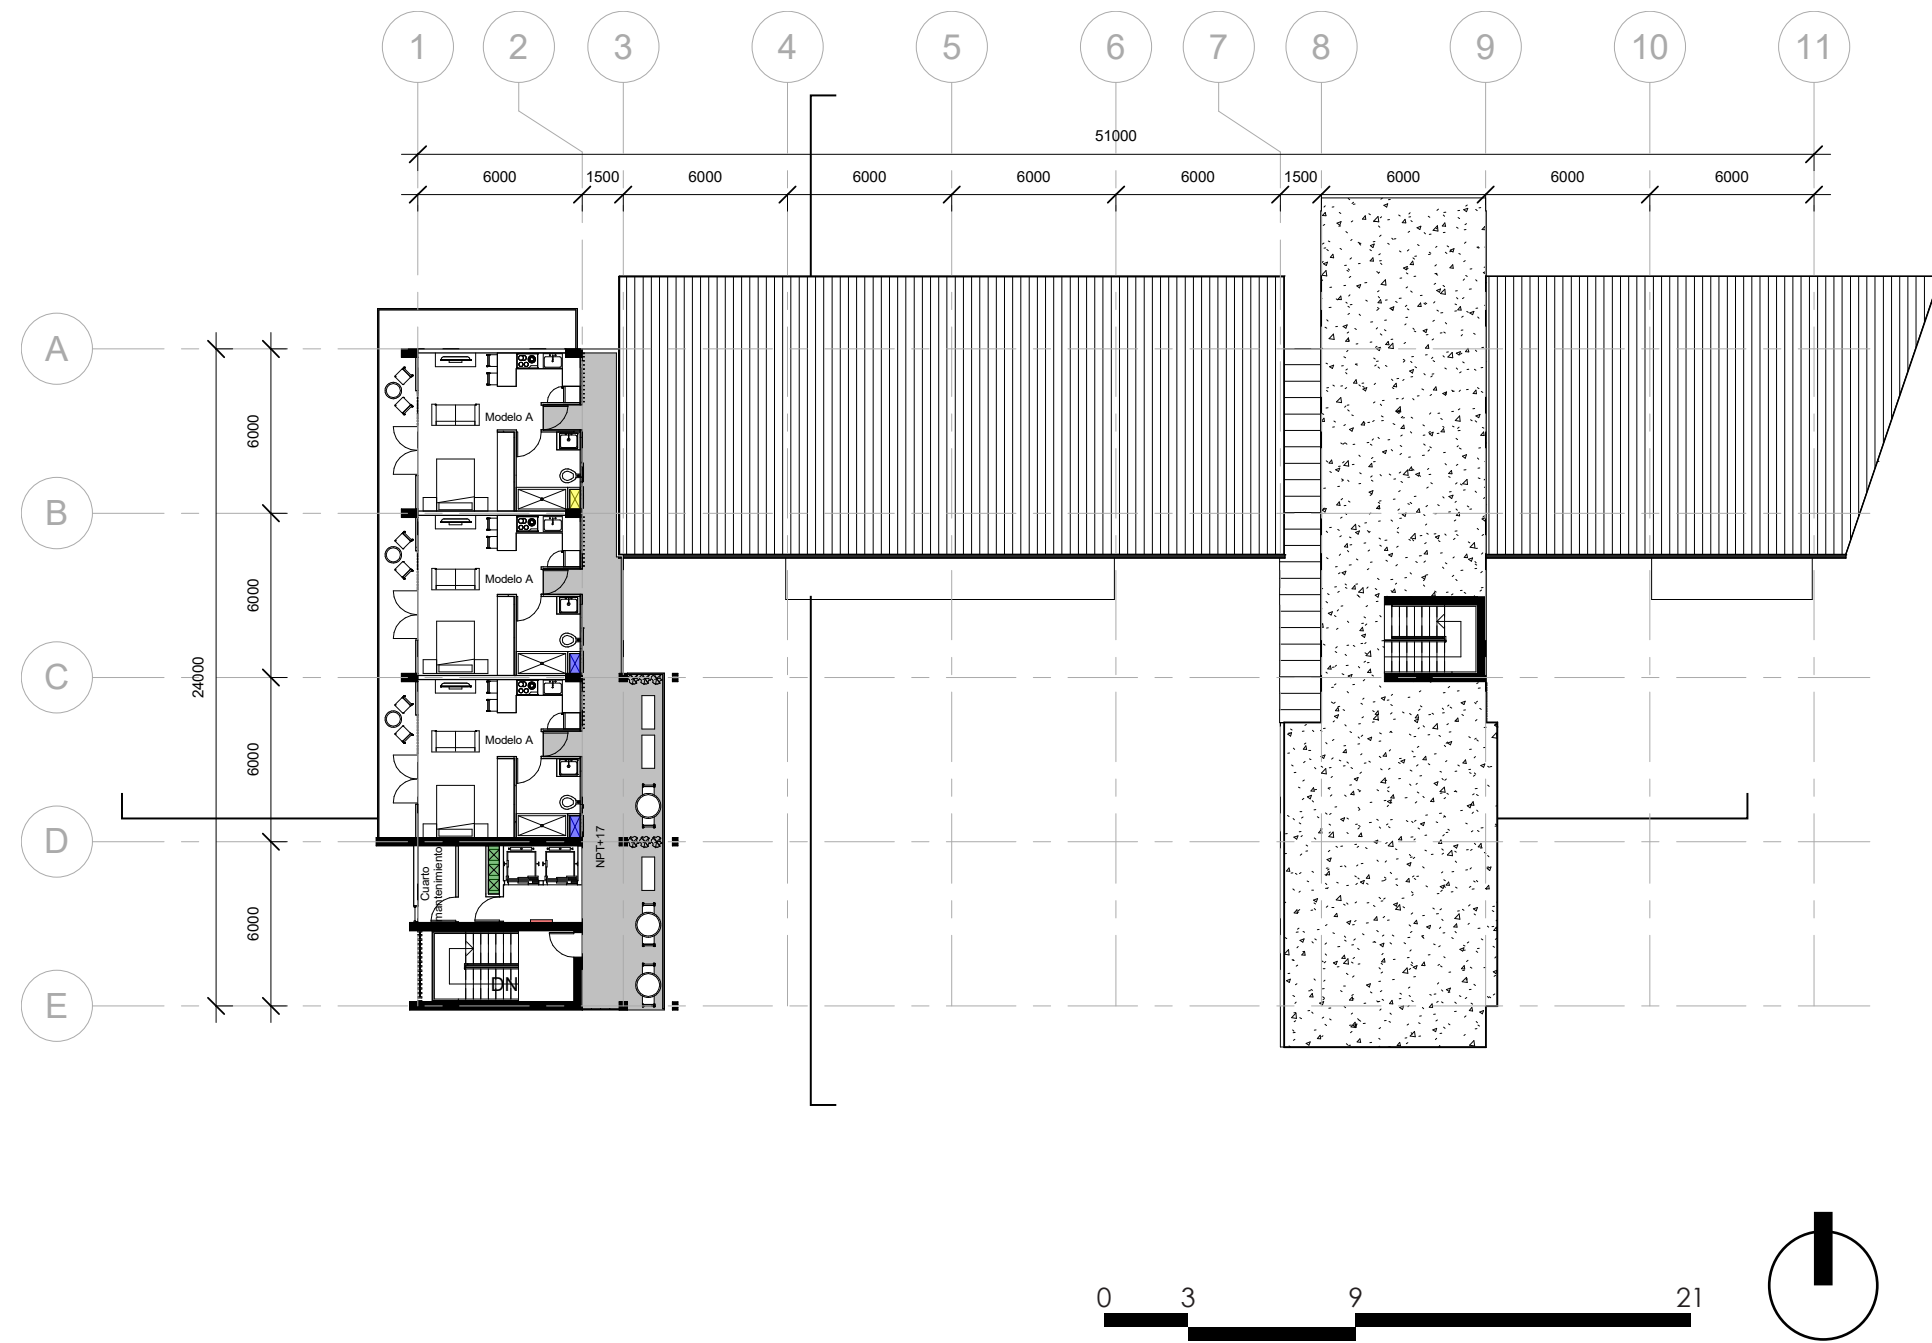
Planta nivel 5. Fuente: Elaboración propia.
